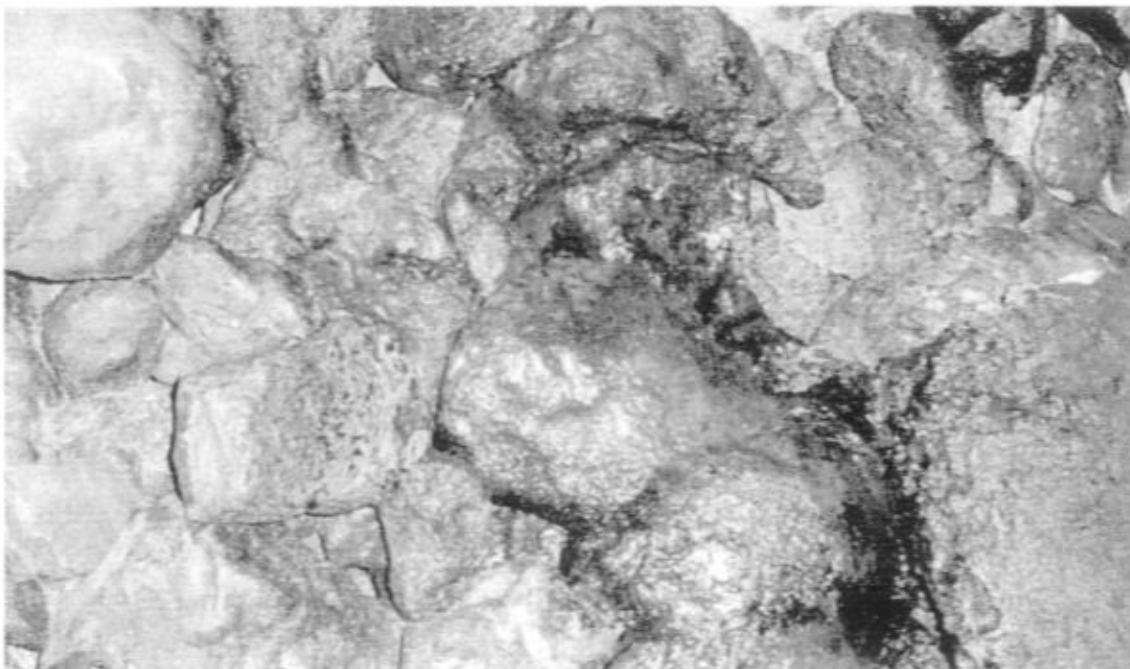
Particolare del gocciolamento sul piano di calpestio.
